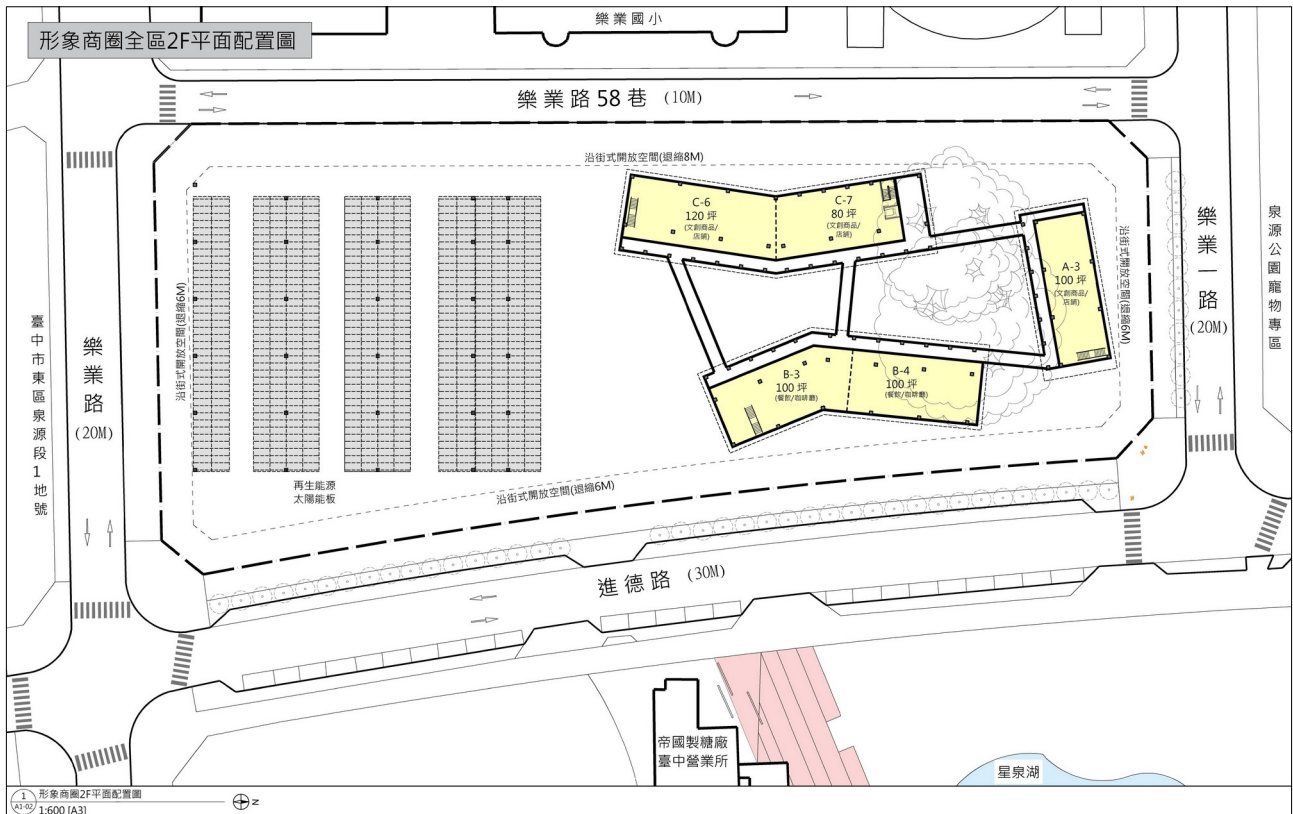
形象商圈 2 層平面示意圖(S : 1/600)
